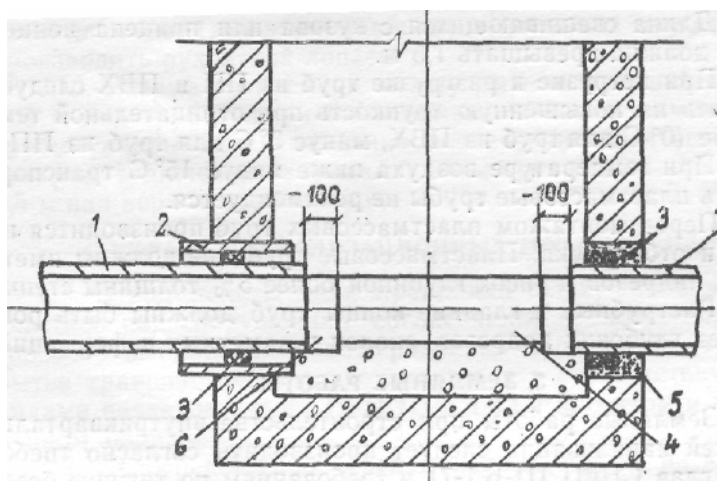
Схема прохода самотечного трубопровода из полиэтиленовых труб через стенки колодца
